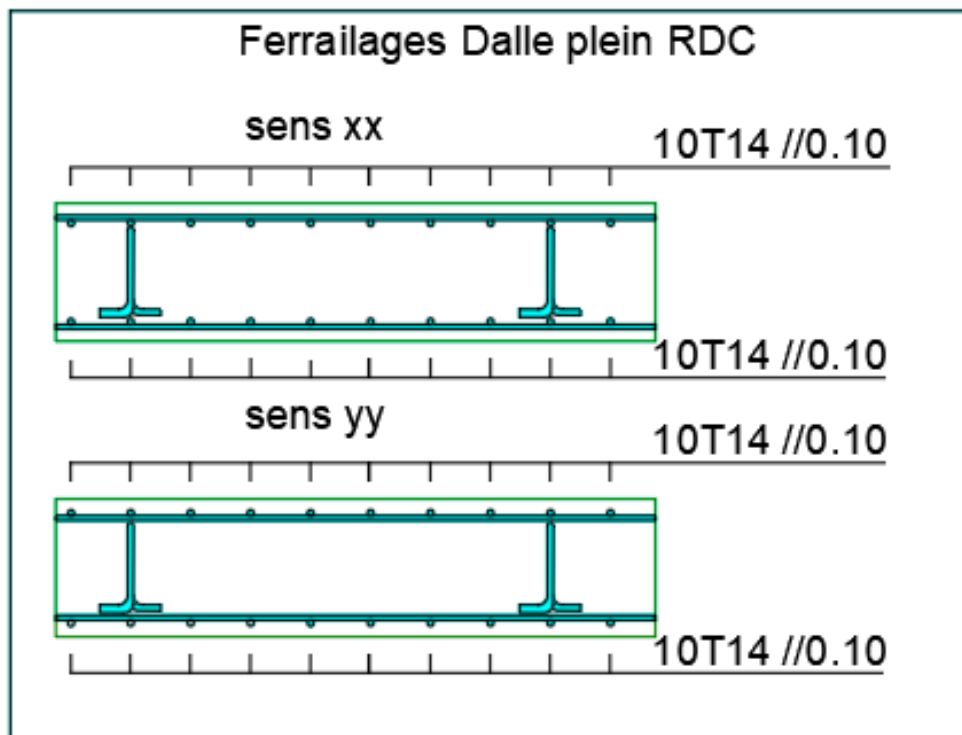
Schéma de ferrailage pour la dalle RDS.
